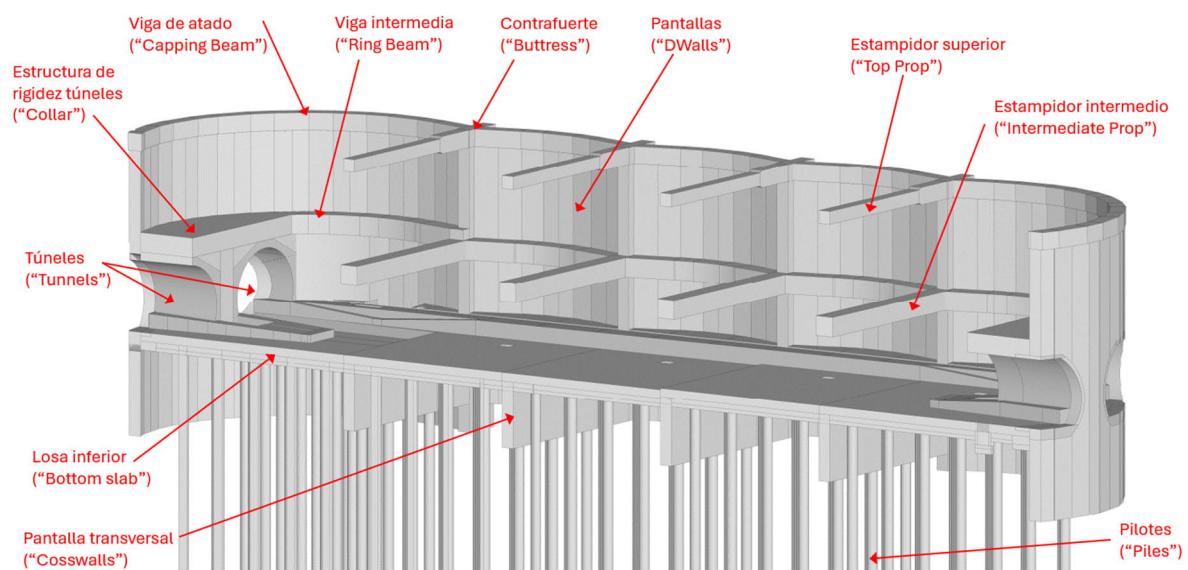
Esquema tridimensional con los elementos estructurales del pozo.
